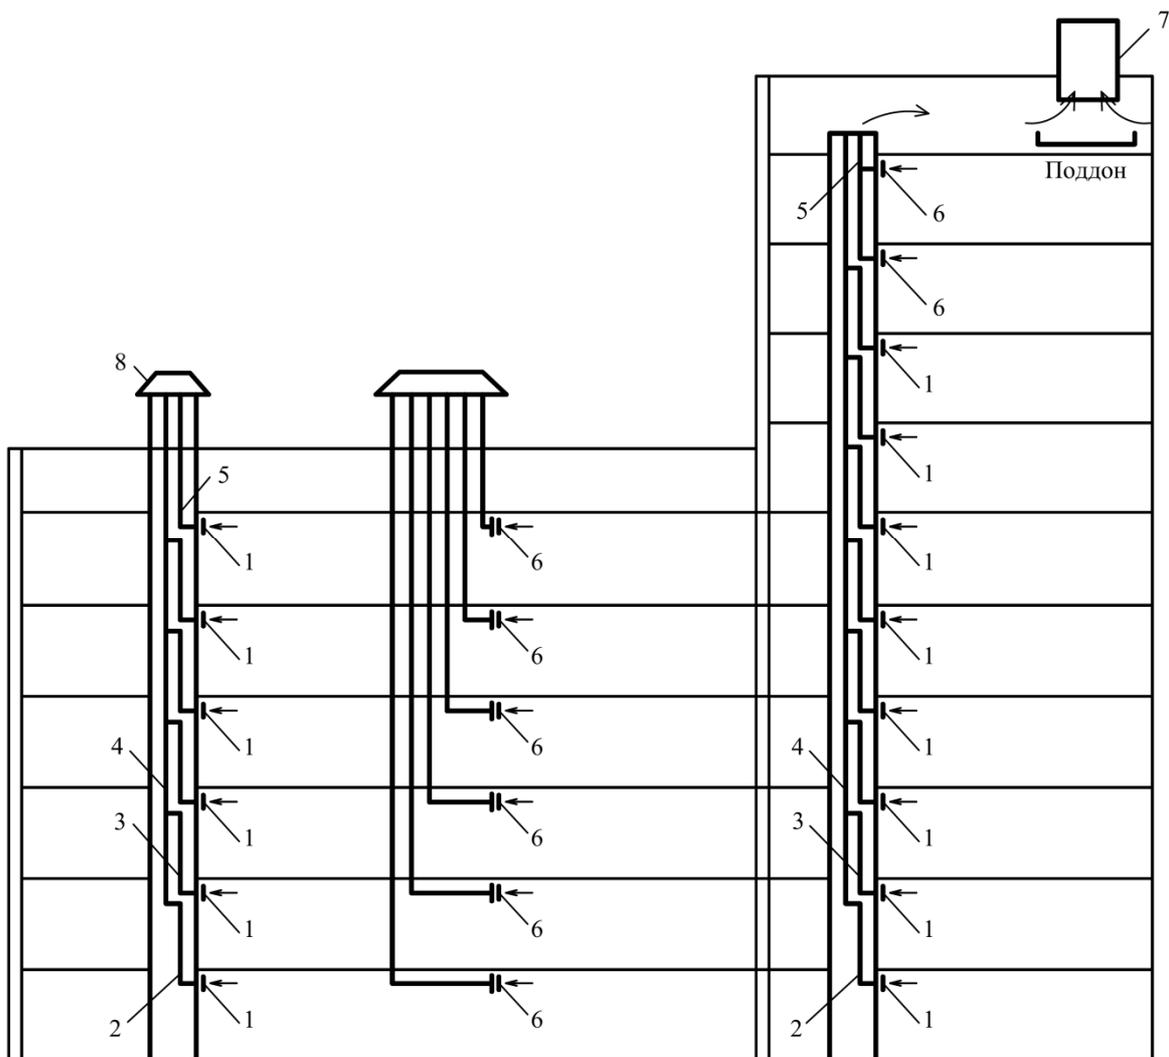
Схемы вытяжной естественной и механической вентиляции: 1 – воздухоприемные устройства; 2 – воздуховод из встроенно-пристроенных помещений; 3 – канал (воздуховод) – спутник с нормируемым пределом огнестойкости; 4 – сборный вертикальный канал (воздуховод с нормируемым пределом огнестойкости); 5 – индивидуальные каналы (воздуховоды) двух последних этажей с нормируемым пределом огнестойкости; 6 – осевой вентилятор; 7 – центральная вытяжная шахта; 8 – крышный вентилятор
